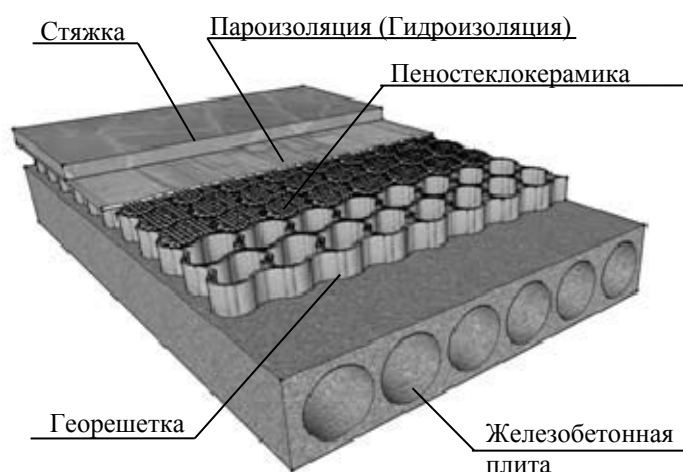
Вариант конструкции системы утепления по железобетонным плитам
